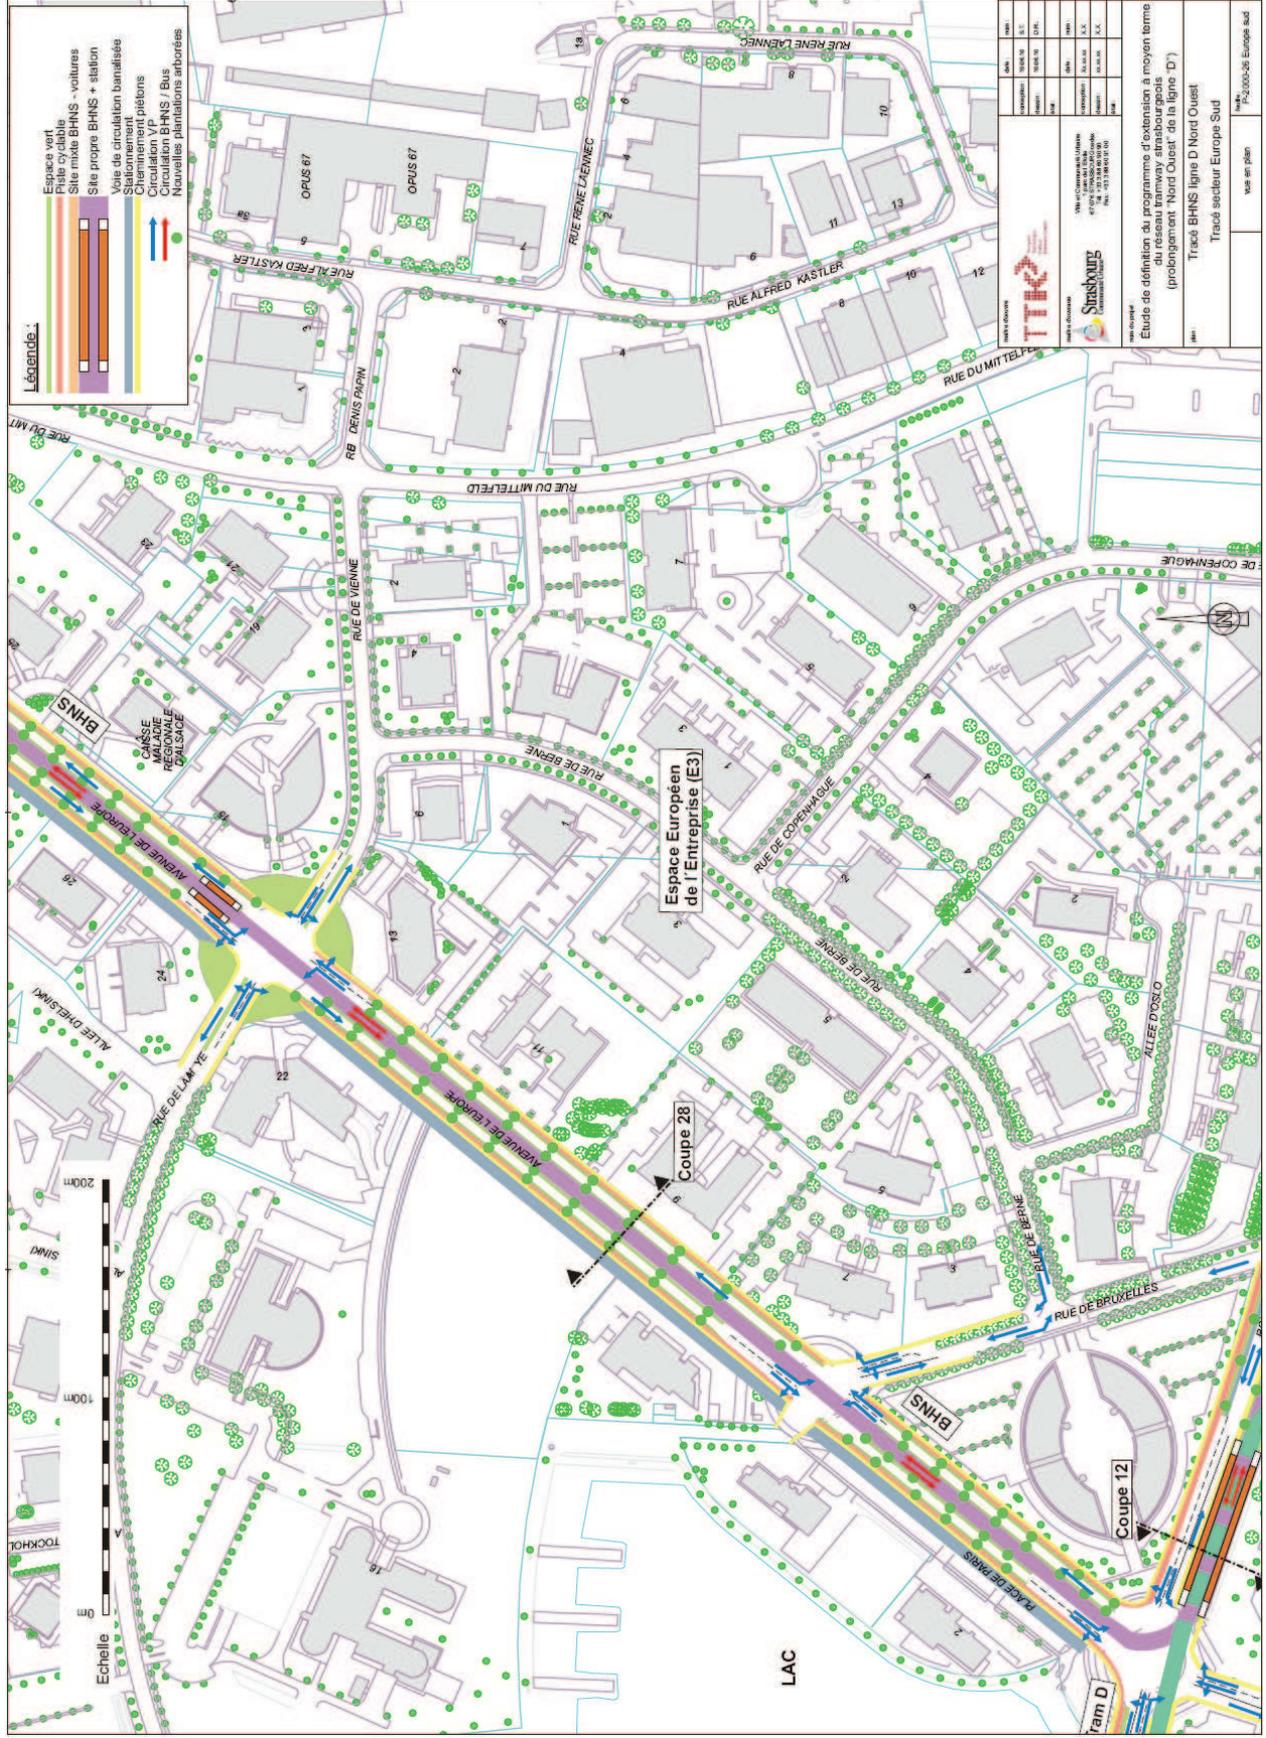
Plan d'insertion du secteur "Europe Sud" (échelle 1/2500^{ème})
